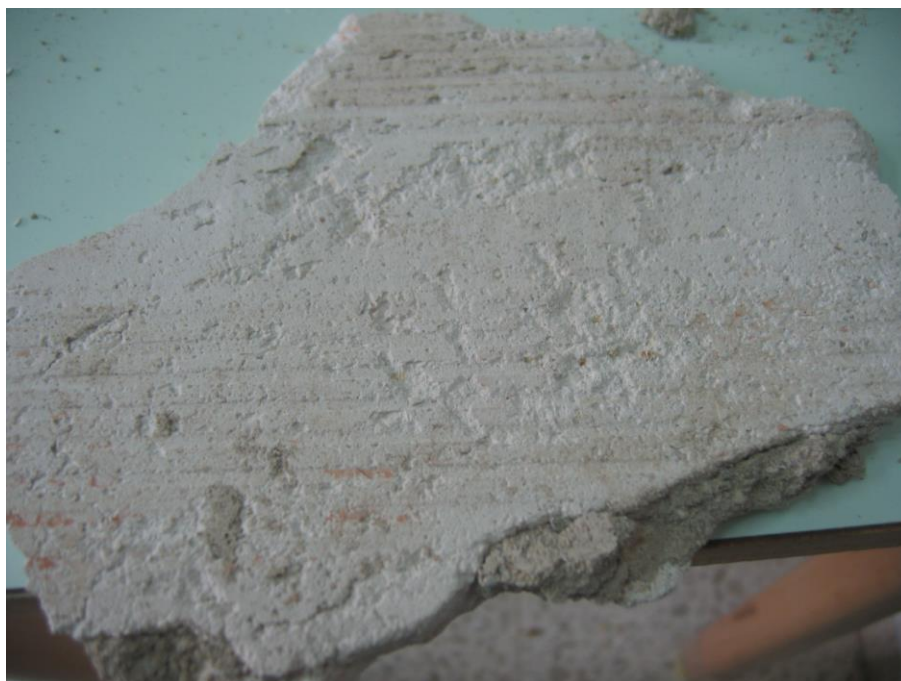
Particolare intonaco distaccato dal soffitto privo di rinzafo.
